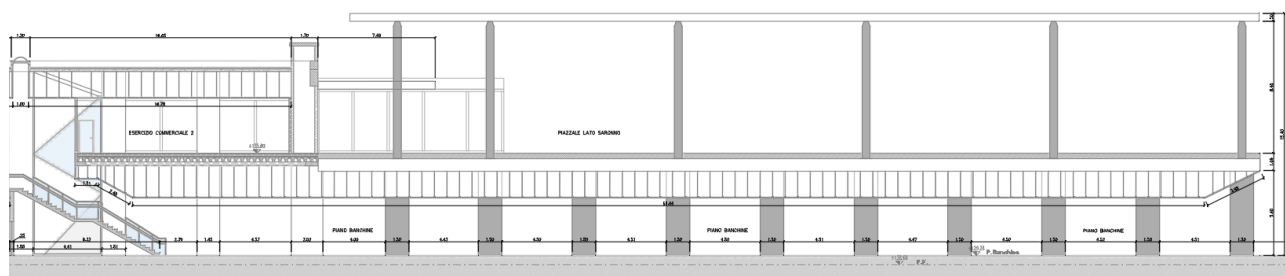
Sezione longitudinale nuovo Piazzale lato Saronno.
